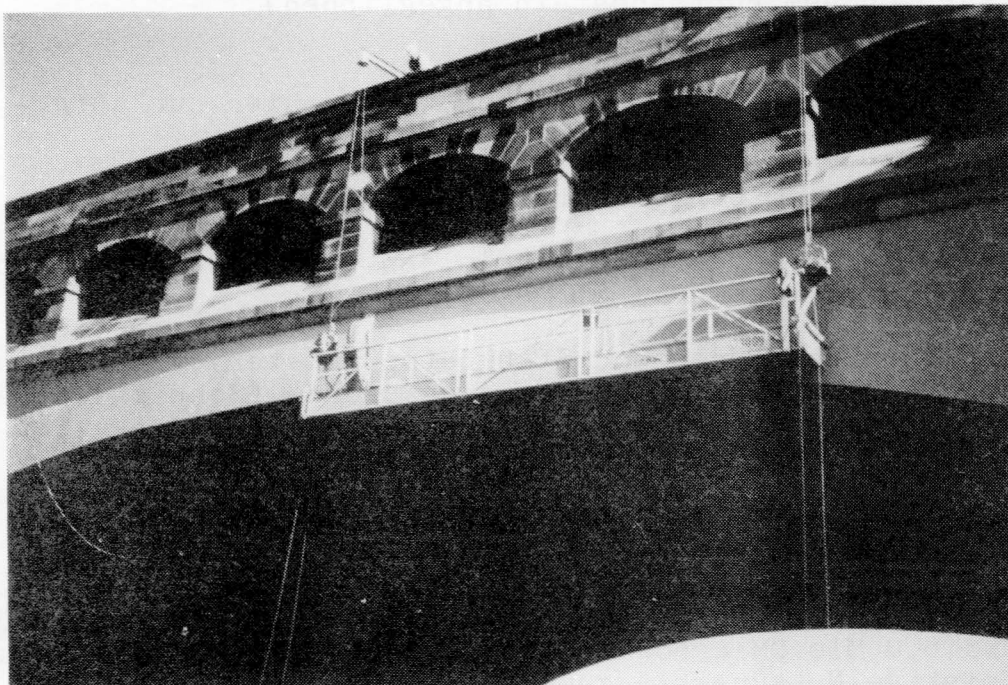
Aufbringen des Betonfarbanstrichs auf die Betonbauteile der Brückenfassade
